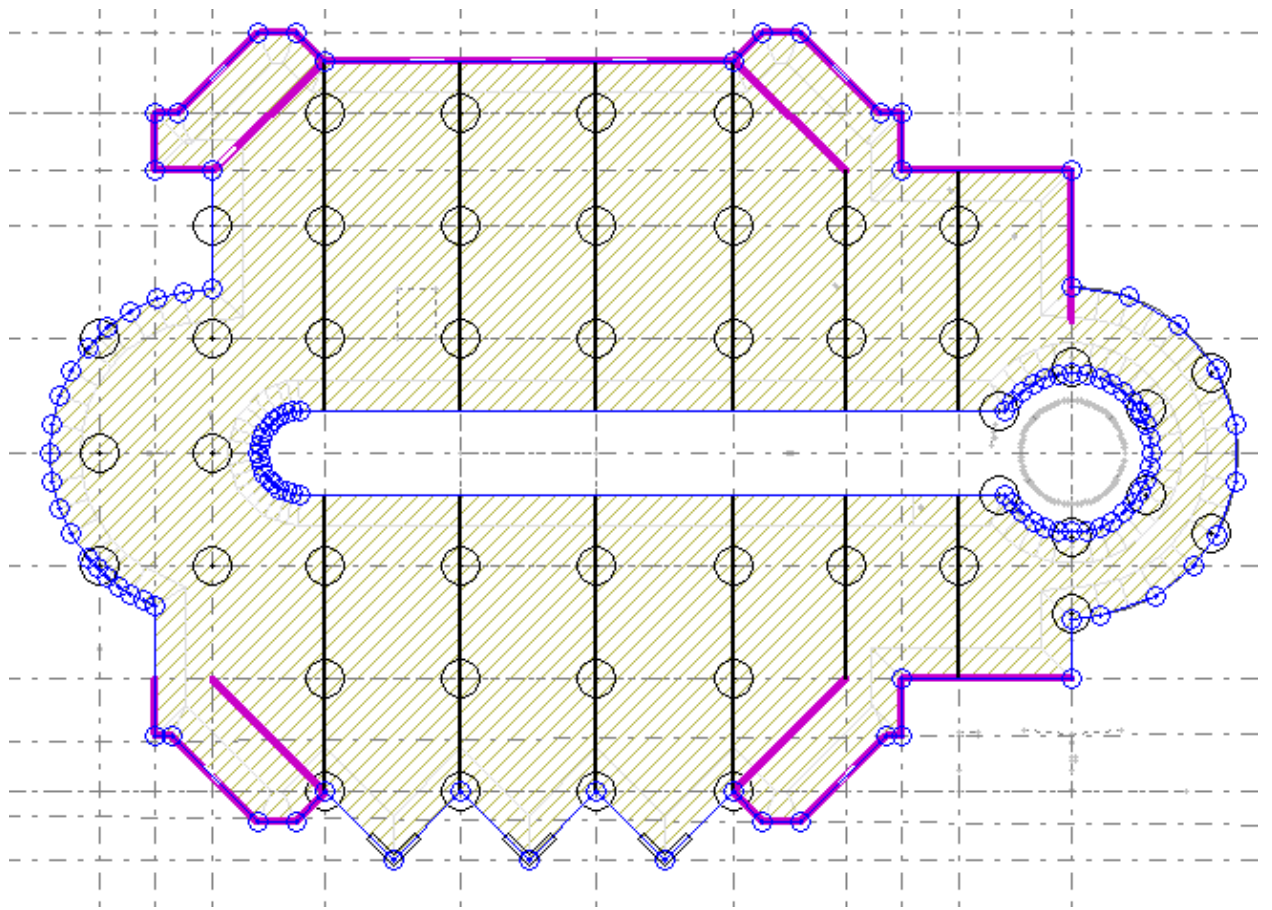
Розрахункова схема 3-го поверху будівлі
